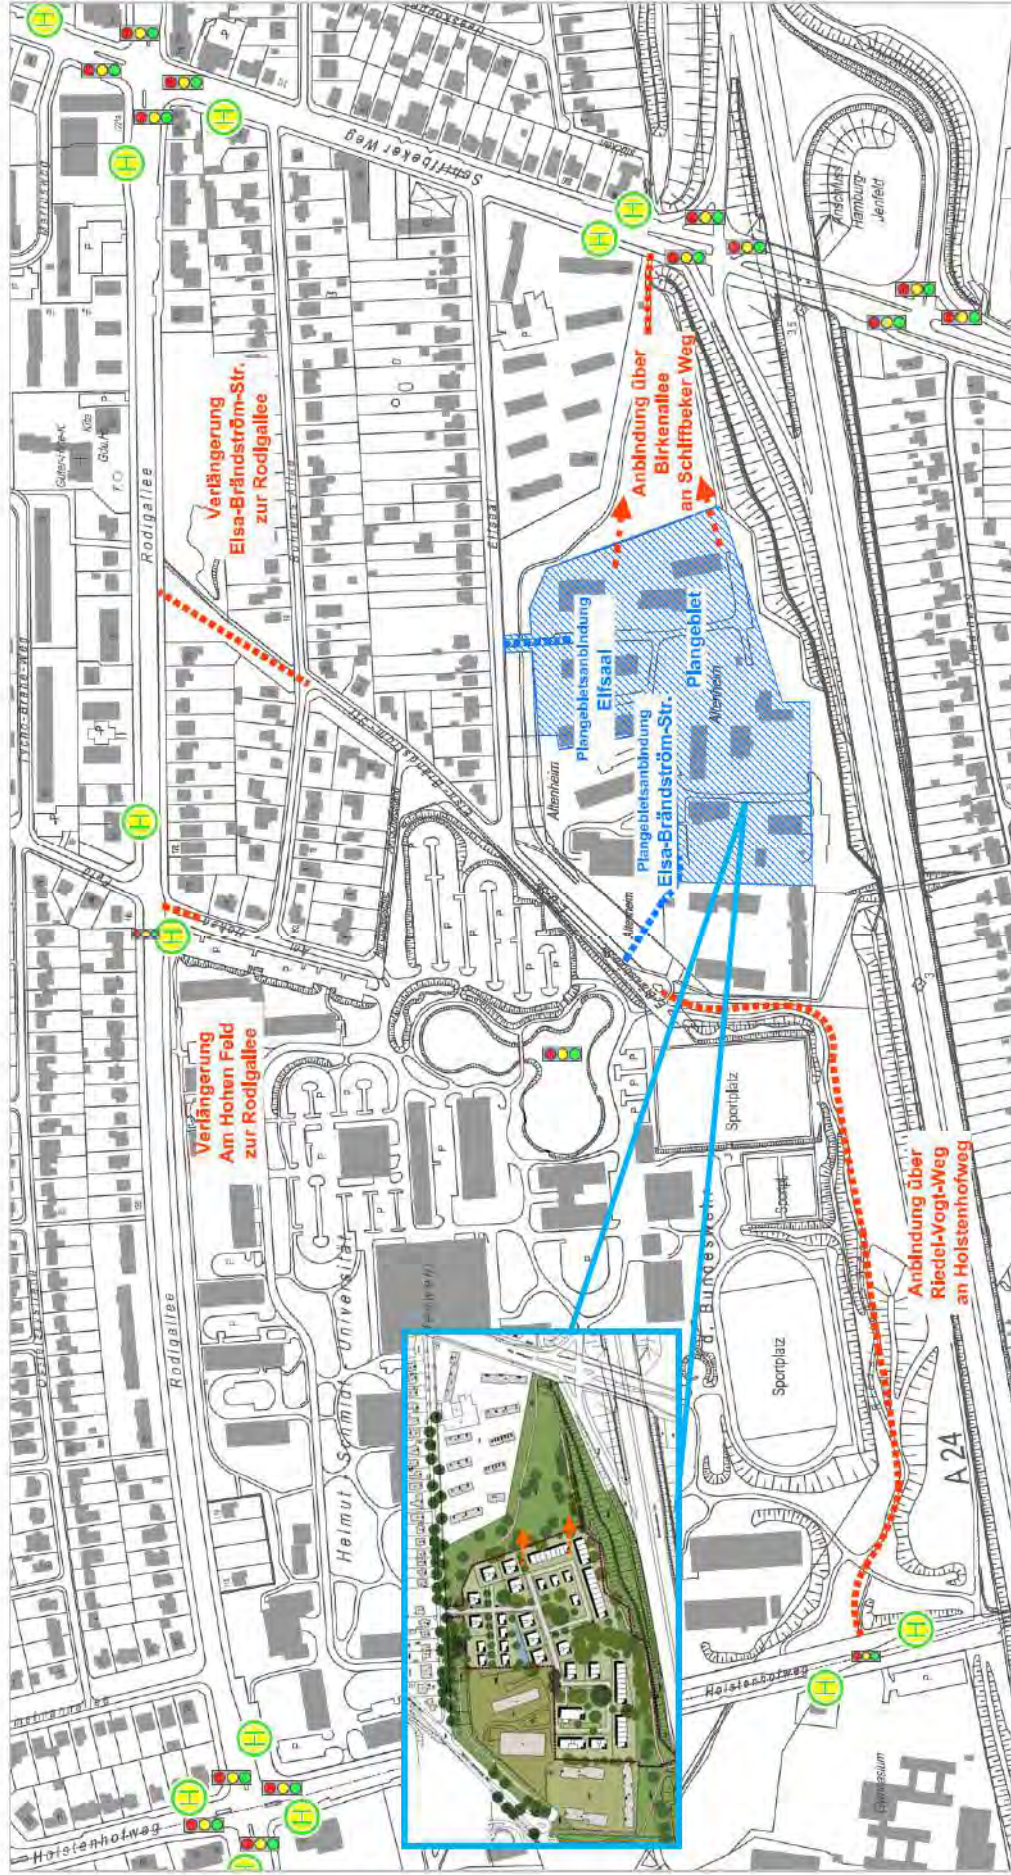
Übersicht Erschließungsvarianten (o.M., Planstand Masterplan WRS 09.02.2010) [3]
